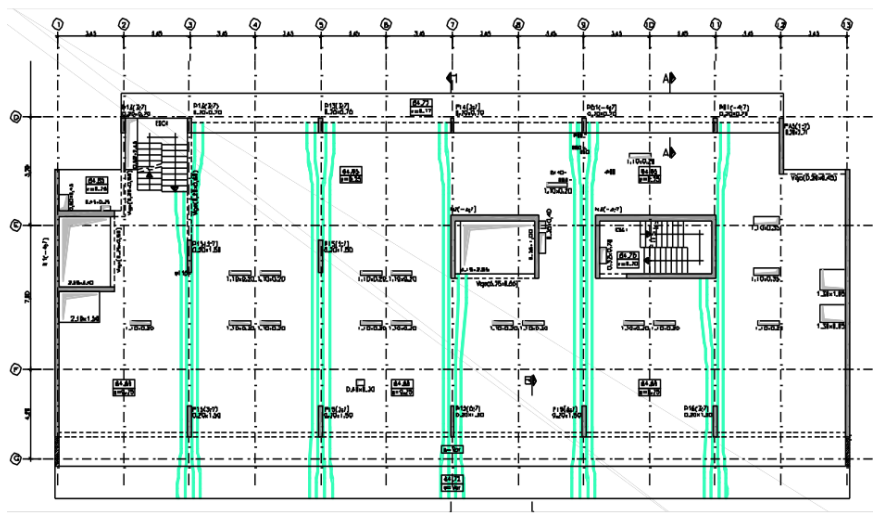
| Planta do Piso 5 e 6 e cobertura (a verde os cabos de pré-esforço)
